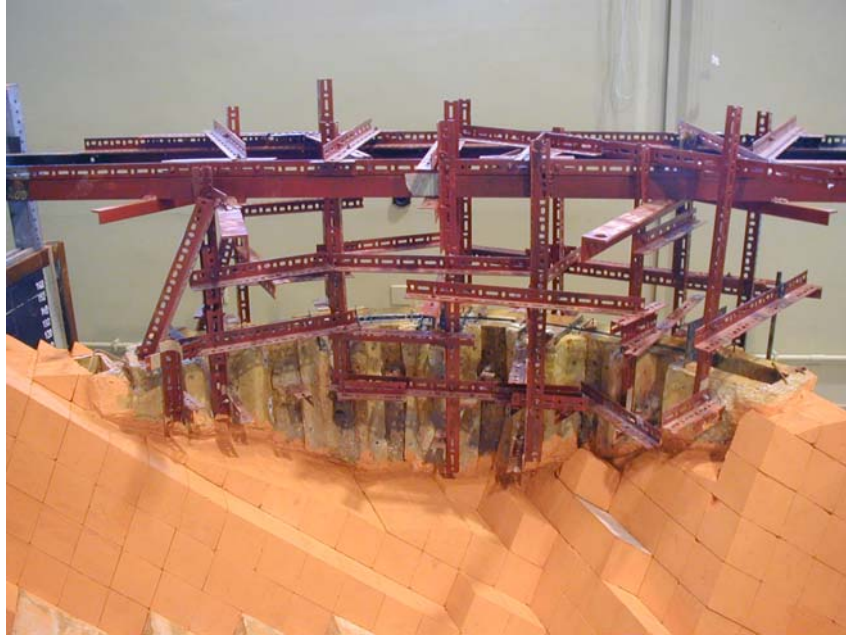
Vista da colocação do molde da barragem sobre a fundação
